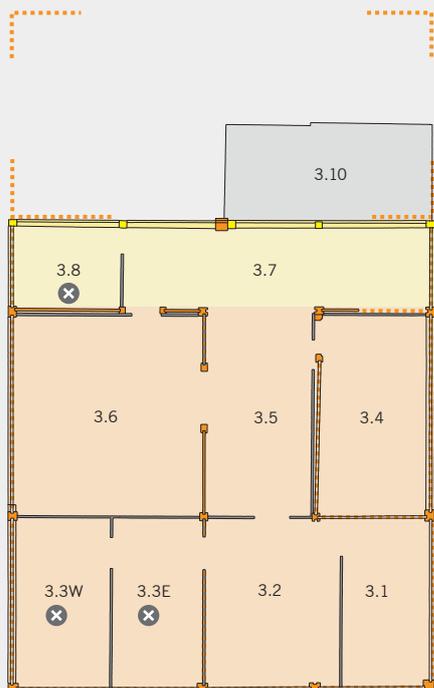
Baar, Rathausstrasse 6/8, Grundriss des dritten Vollgeschosses.
